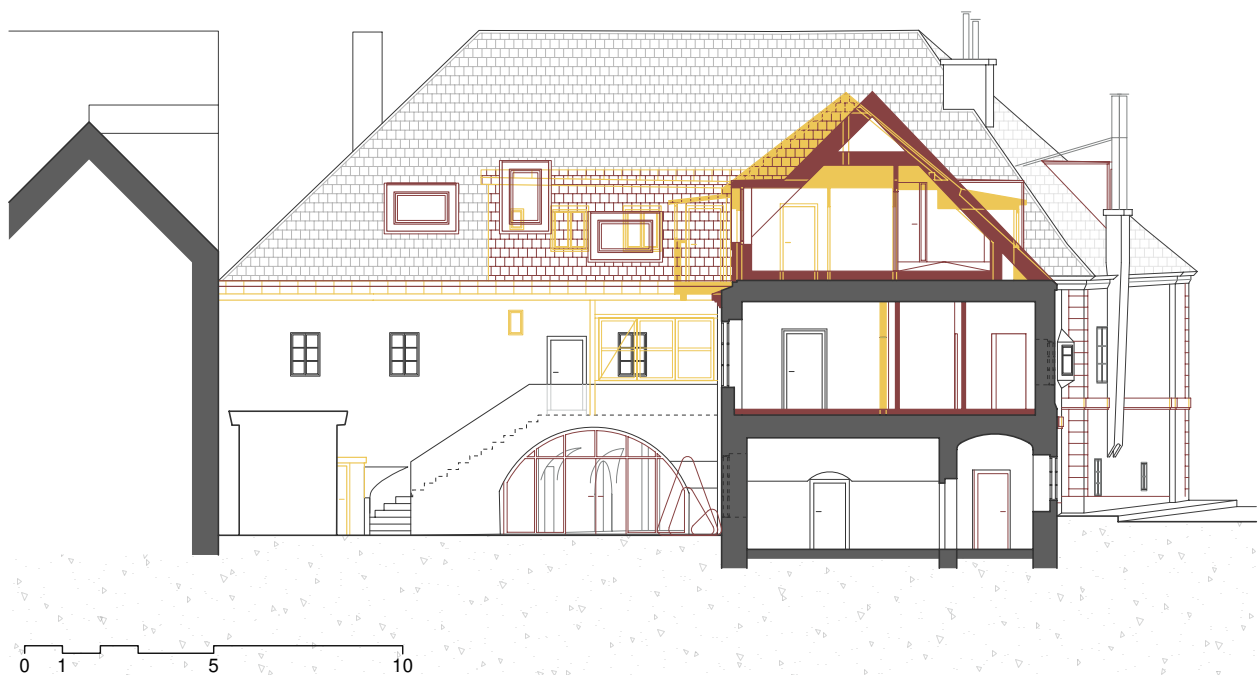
Bauliche Eingriffe Schnitt B-B M 1:200
